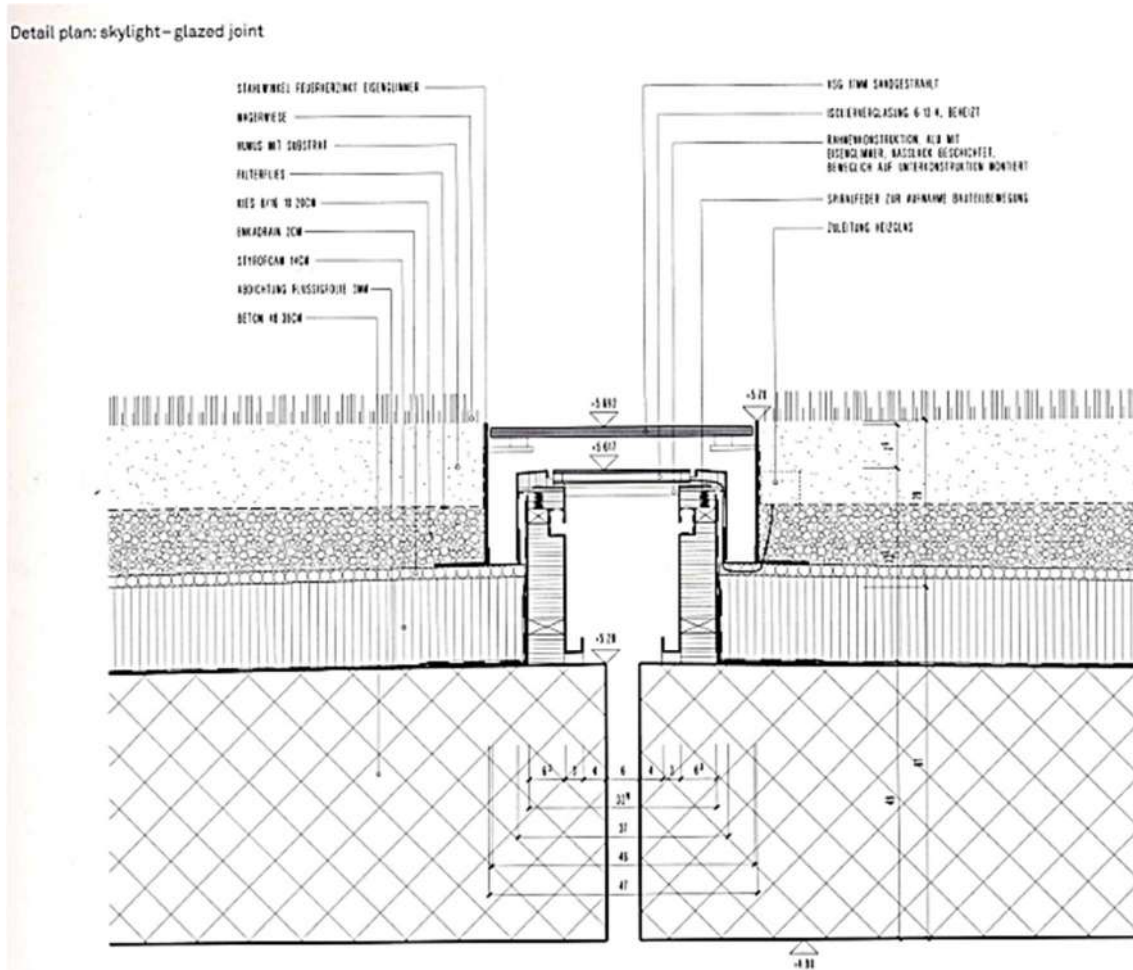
Pormenor das fendas entre lajes da cobertura. Reproduzido de Zumthor, 2008:104.
